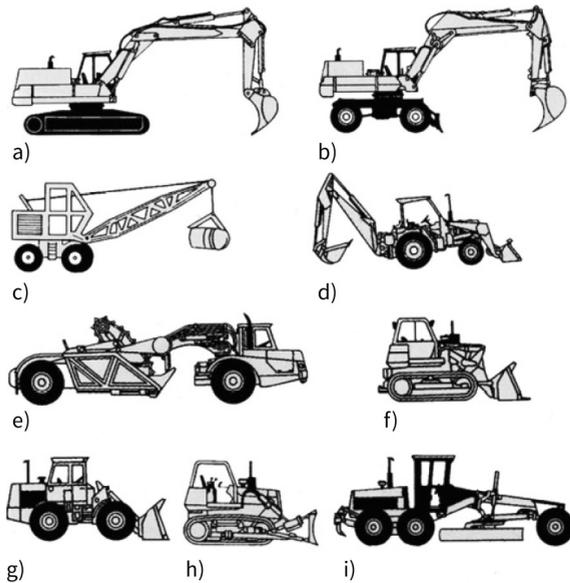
Erdbaumaschinen zum Lösen, Laden, Transportieren und Planieren (nach [47]);
